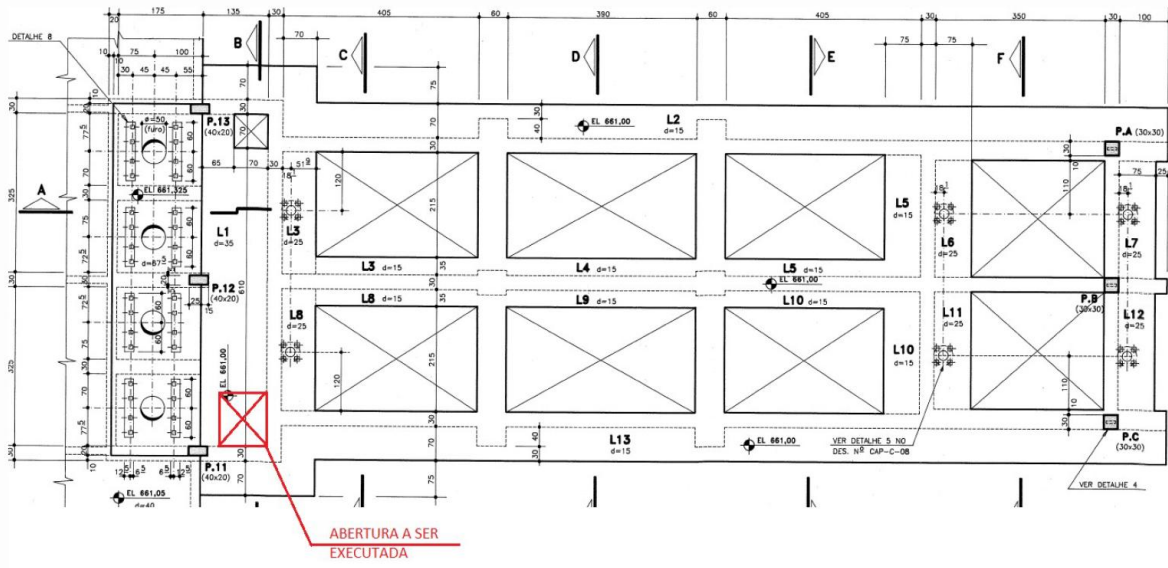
Planta superior do tanque - Croqui das intervenções a serem realizadas
